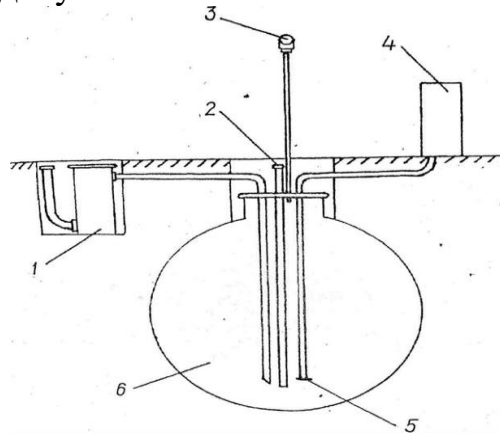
Схема АЗС: 1 - зливний пристрій; 2 - замірний пристрій; 3 - клапан дихальний; 4 - паливороздавальна колонка; 5 - відбірний клапан; 6 - резервуар
